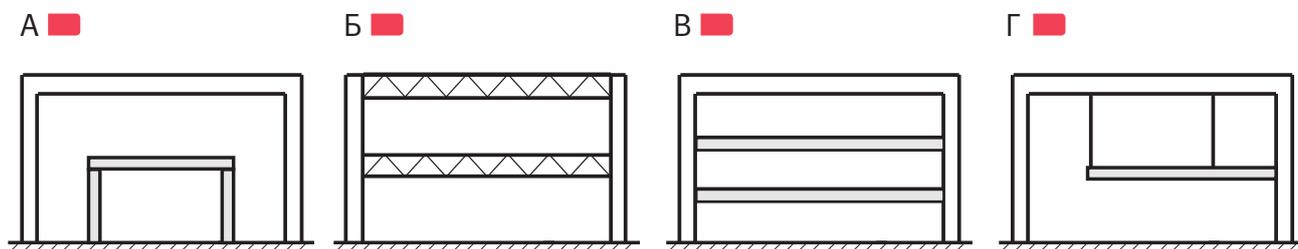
Замена и устройство новых перекрытий и покрытий при реконструкции и капитальном ремонте: А – внутренние балочные клетки; Б – перекрытия обычной высоты; В – перекрытия сниженной высоты; Г – подвешенные этажи
